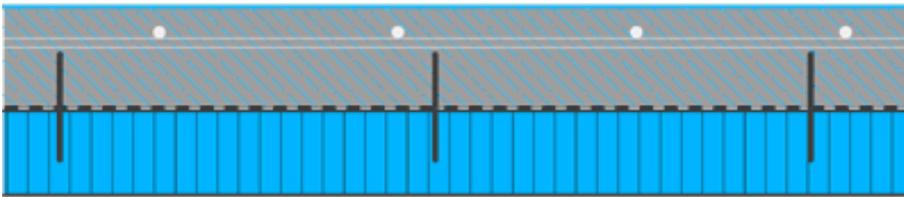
Holzbalken und Ortbeton¹³⁴
